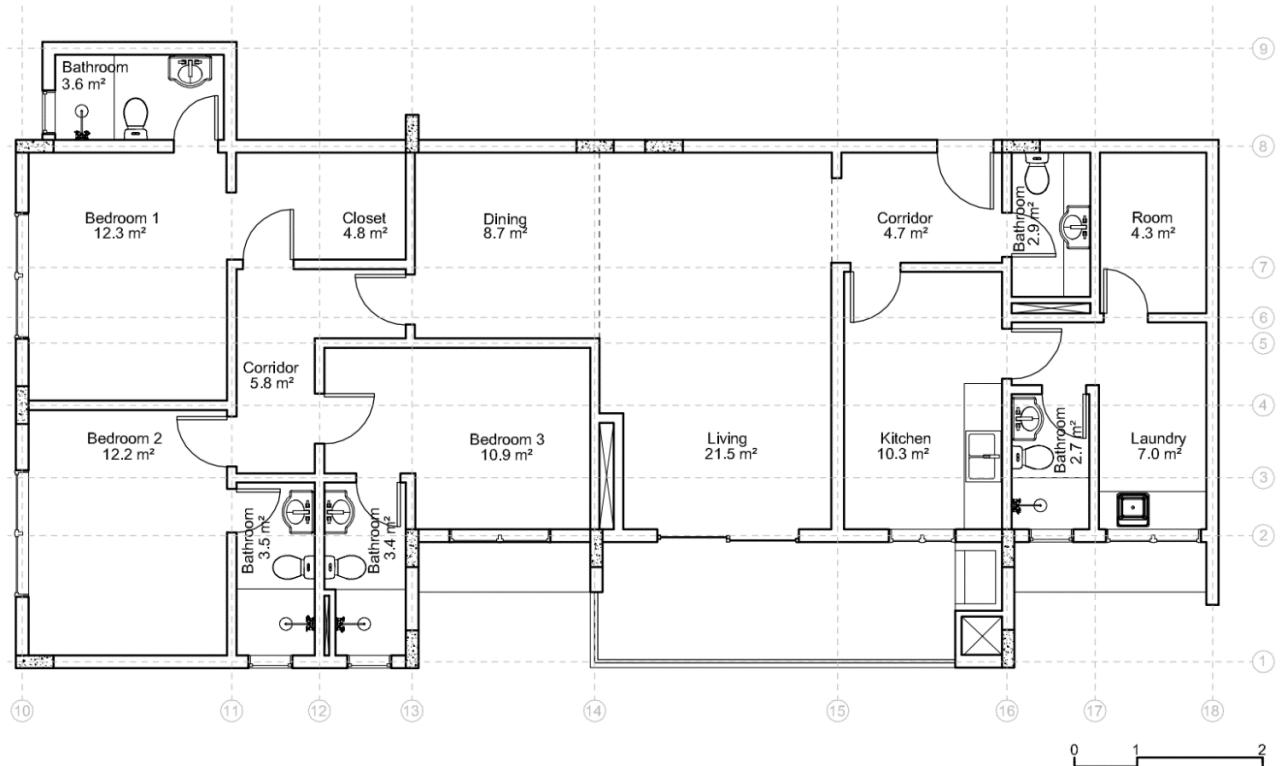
Planta baixa Vista da Montanha no Revit.
